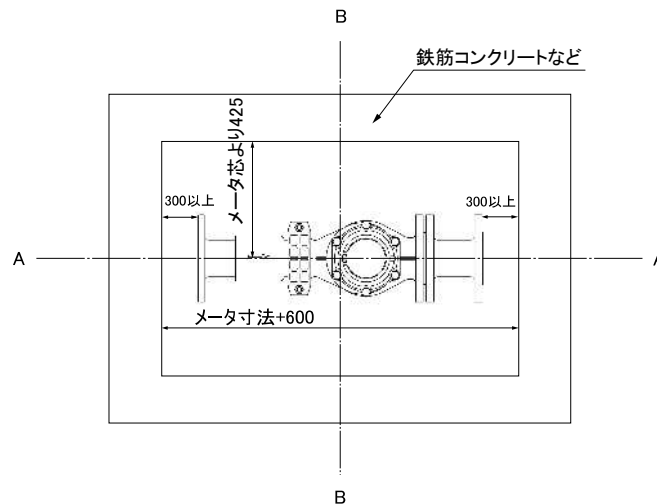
4 9 メータボックス標準図 (50 mm平面図)
